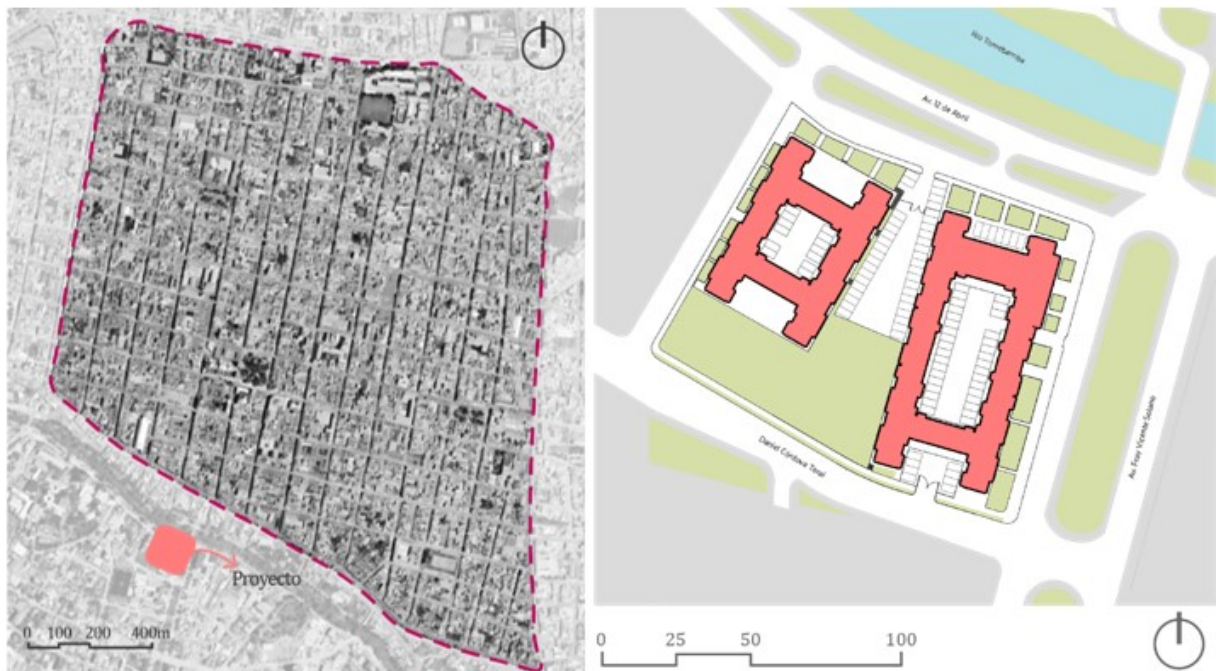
Ubicación y Emplazamiento del proyecto
